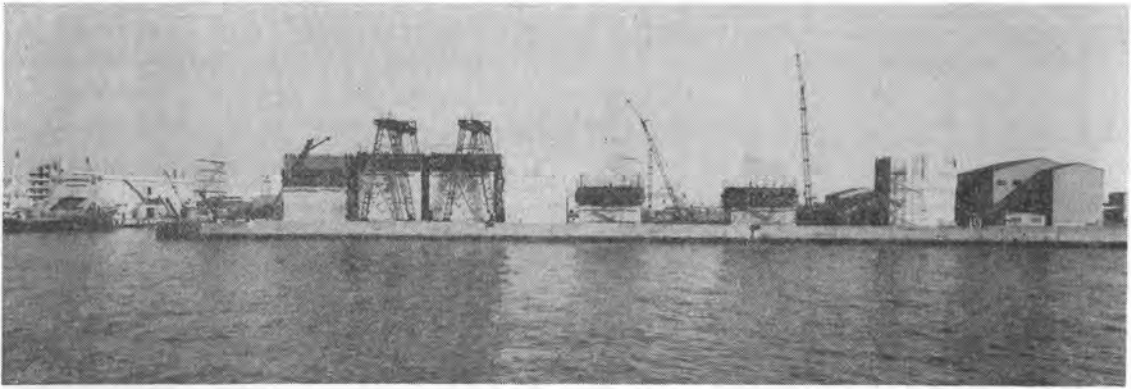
(A) 神戸港の岸壁工事施工状況(その1)
